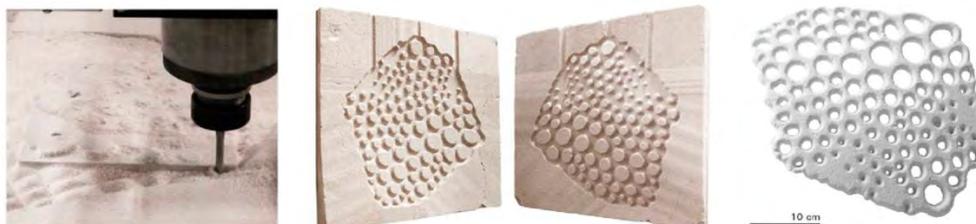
Методы опалубки для геометрически сложных бетонных конструкций. Фрезерование опалубочной части, сборка двусторонней опалубки для литья, вид тонкостенного бетонного сегмента
